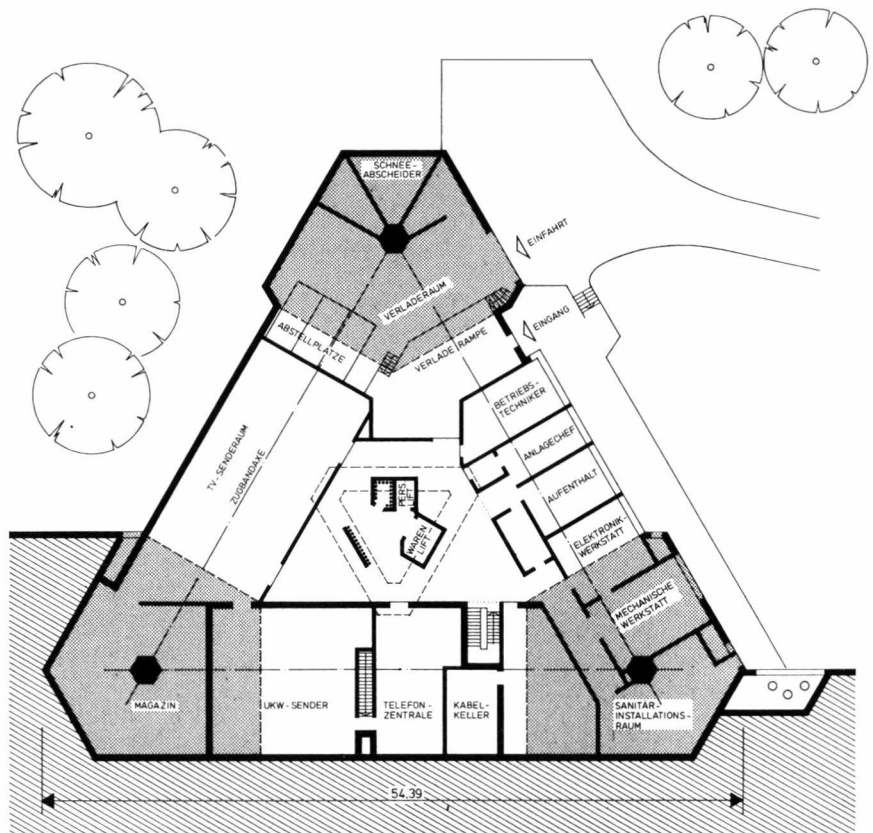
Grundriss Sockelgeschoss -1 – Plan du sous-sol -1 – Plan of the basement -1
